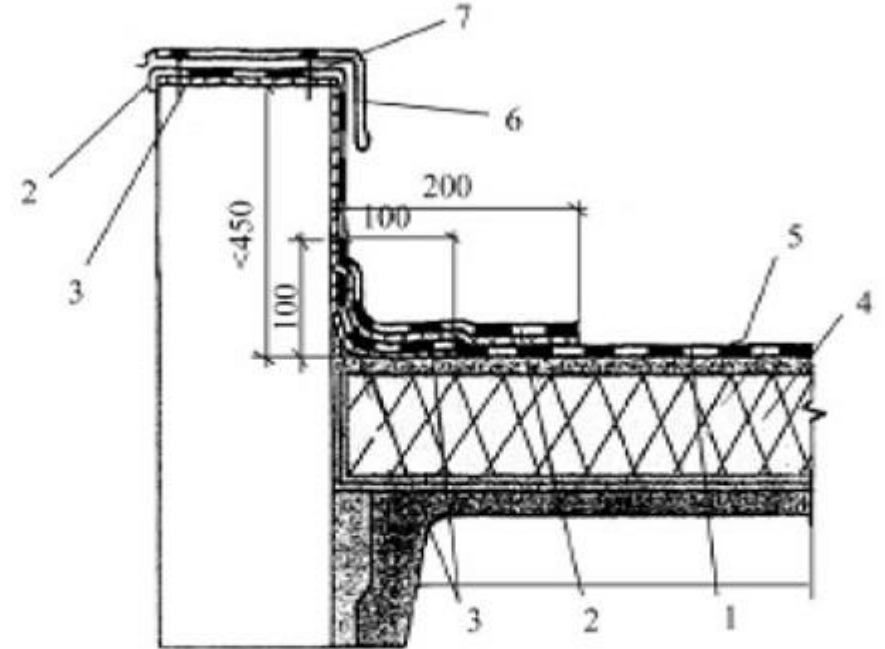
Примыкание кровли к парапету высотой до 450 мм:
